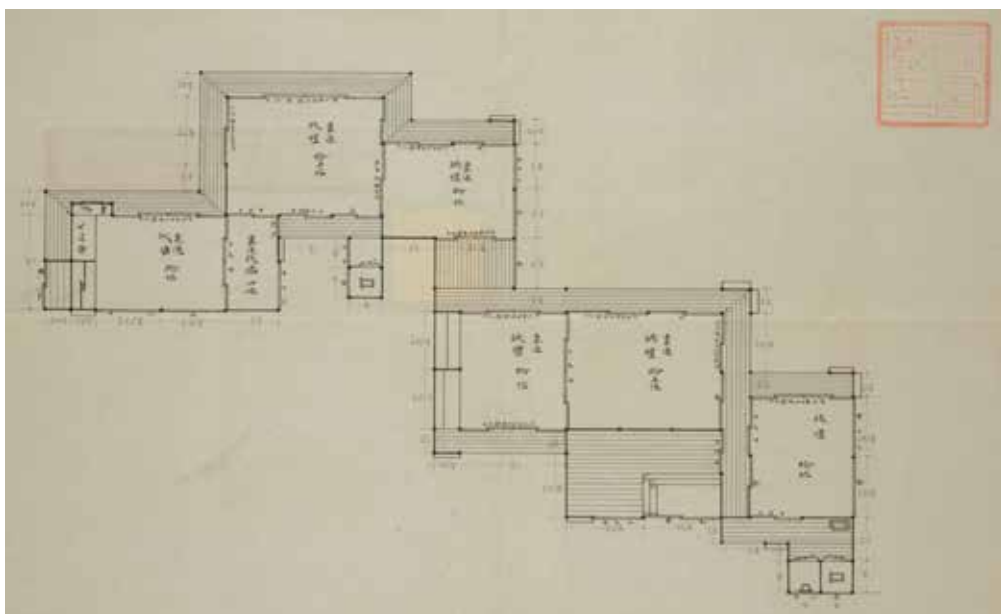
赤坂離宮広芝御茶屋平面図（「赤坂離宮各御茶屋平面図」のうち）
